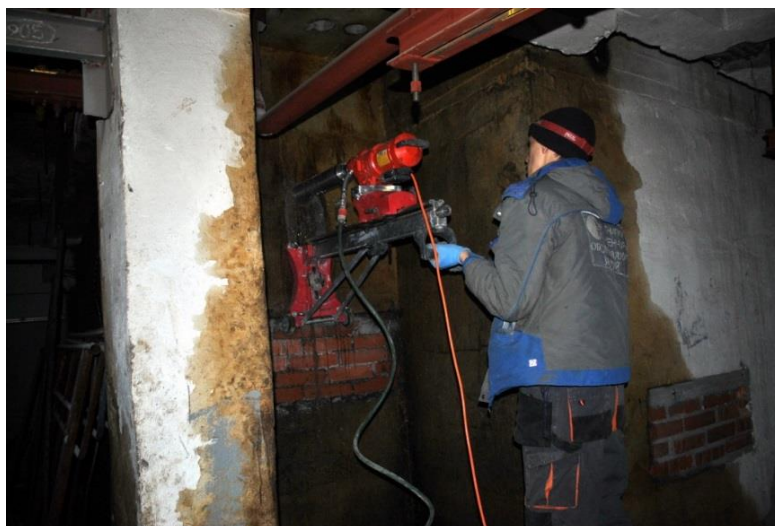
Промасливание бетона сводиков балочного перекрытия
